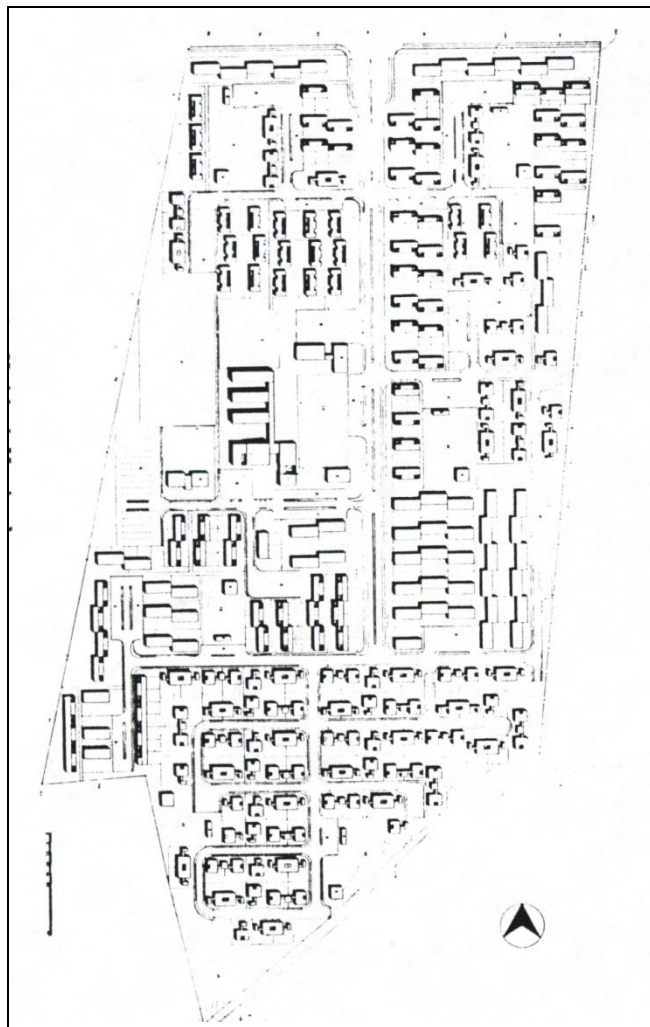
b. UV Chuparín. Plano de Conjunto. Proyecto (1952)
